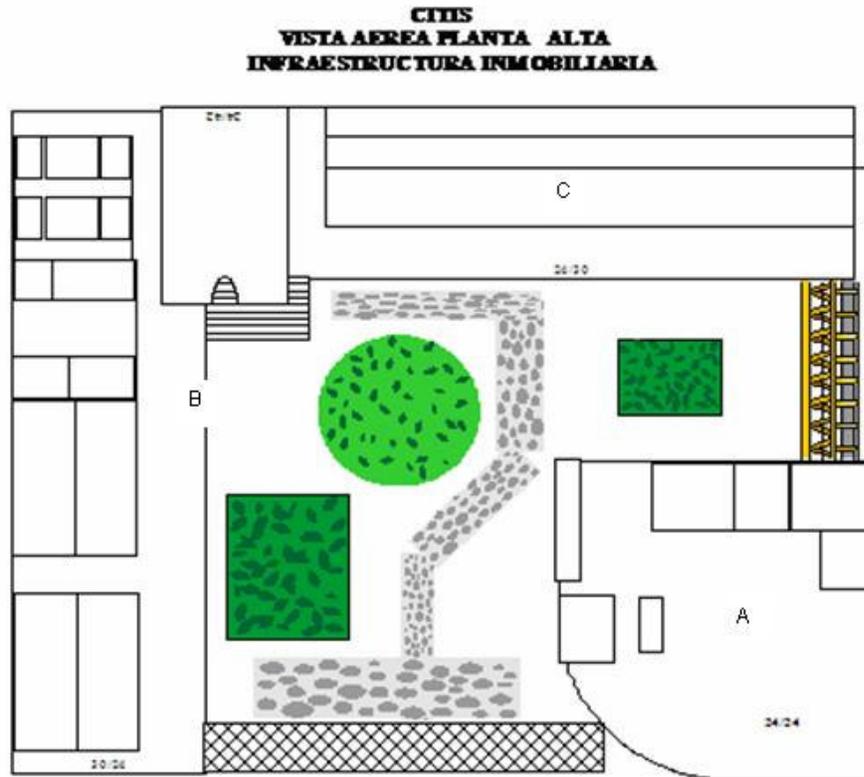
Secciones del CITIS donde puede ser implantado las terminales físicas en la planta alta.
